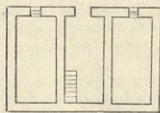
б. План дома с крытым двором: А—I этаж—помещение для скота, Б—II этаж—живое помещение
